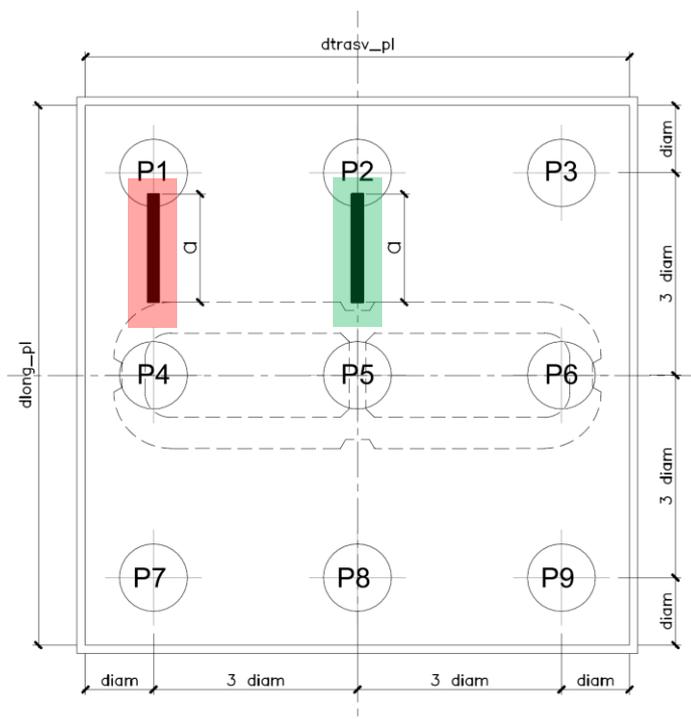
Vista in pianta - Tirante-puntone centrale (verde) e di spigolo (rosso)
